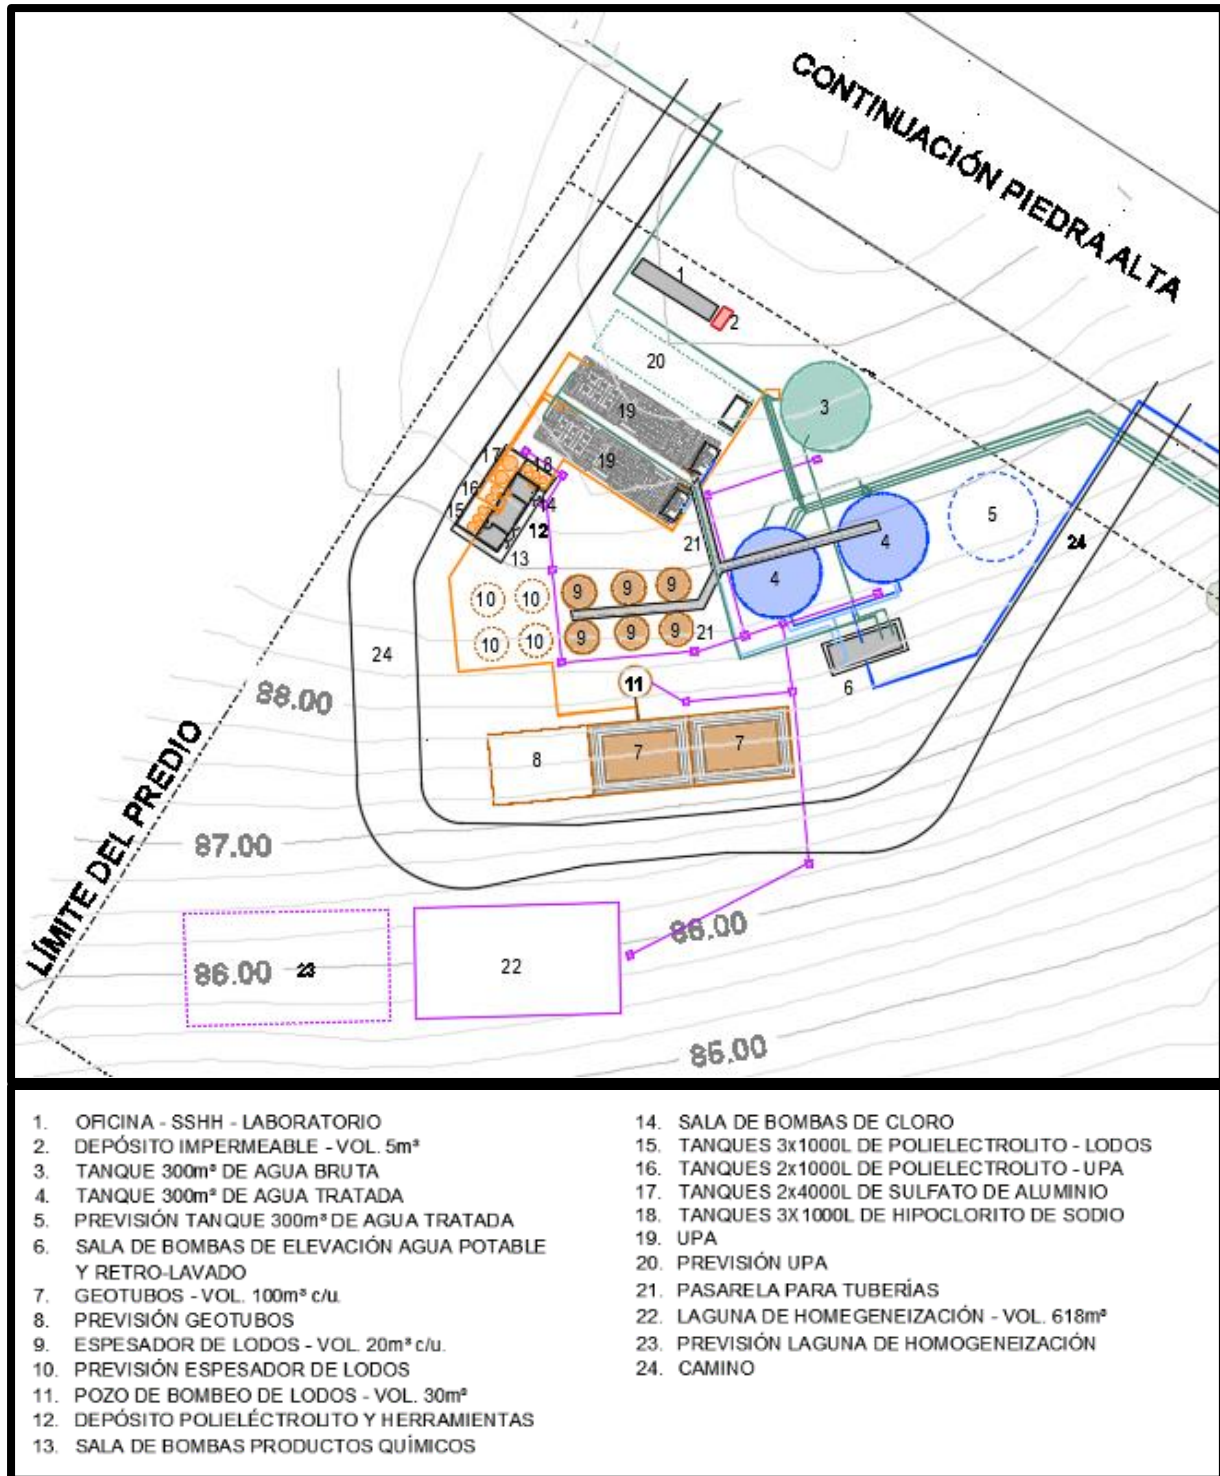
Implantación preliminar de la Planta de Tratamiento
